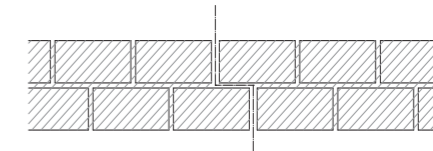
Junta de movimiento con solape. Esquema en planta
